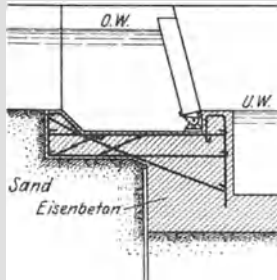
In Eisenbeton bei Sand- oder Lehm Boden.
